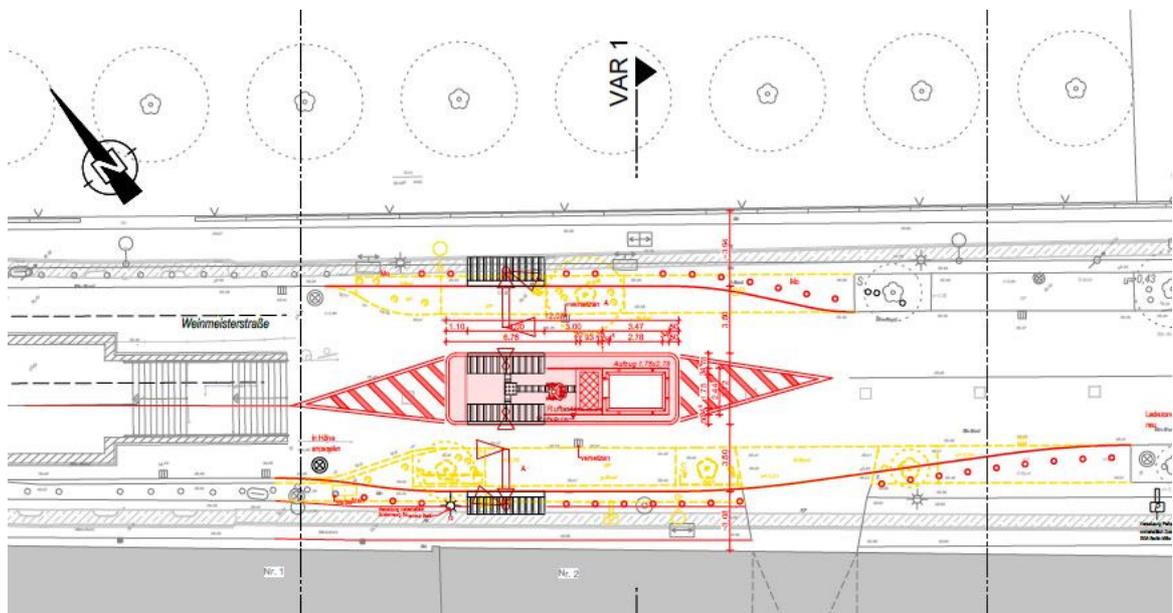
Vorzugsvariante, Ausschnitt Plan W_PG001
